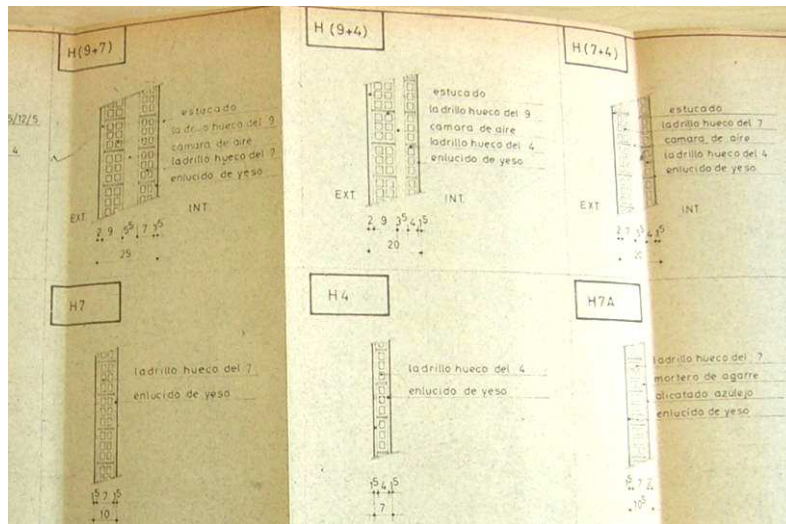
Detalle tabiquería, Edificio ficha 215C.015, 1969.
